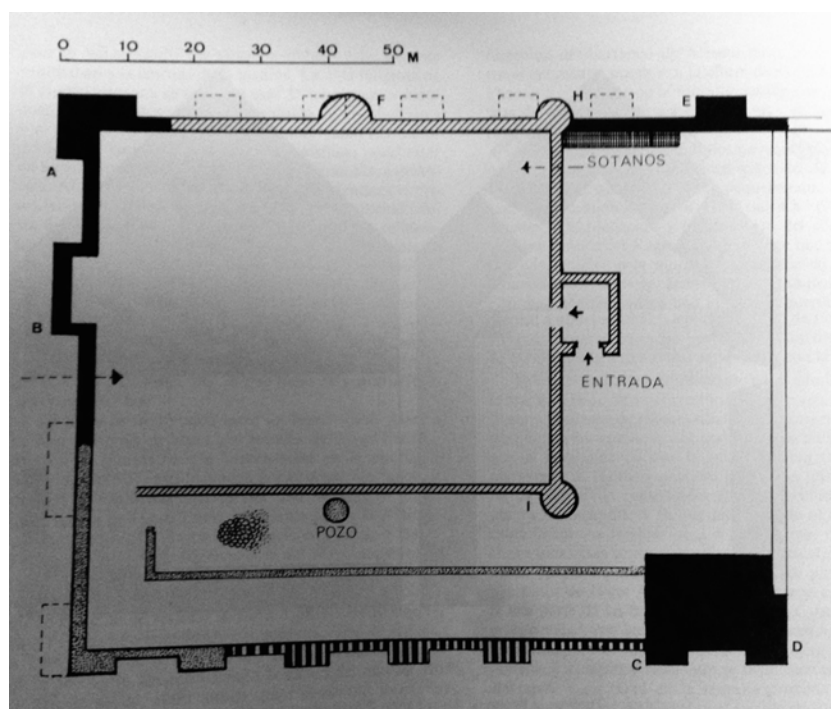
Planta del Alcázar. 1984. B. Pavón Maldonado
